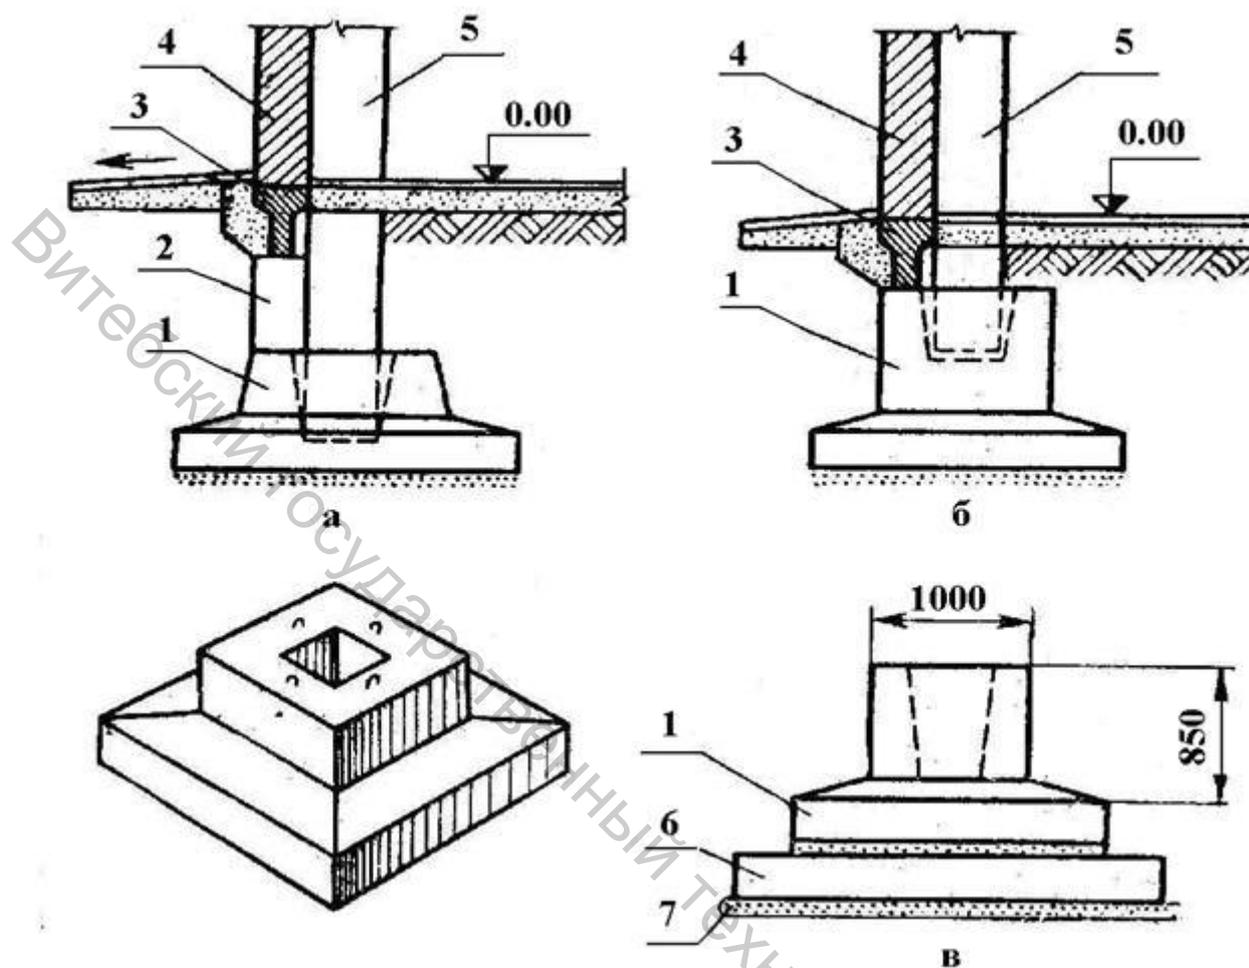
Сборные железобетонные фундаменты стаканного типа под колонны (а – стаканного типа, б – с повышенным стаканом, в – составной фундамент): 1 – фундамент (башмак), 2 – бетонный столбик, 3 – фундаментная балка, 4 – самонесущая стена, 5 – колонна, 6 – плита, 7 – бетонная подготовка
